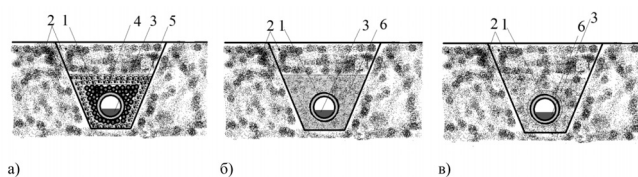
Конструкции дренажа: а – многослойная обратная обсыпка; б – однослойная обсыпка мелким песком; в – труба с защитной оболочкой, 1 – дренажная труба, 2 – местный грунт, 3 – вода в дренажной трубе, 4 – щебень или гравий, 5 – крупный песок, 6 – мелкий песок.
